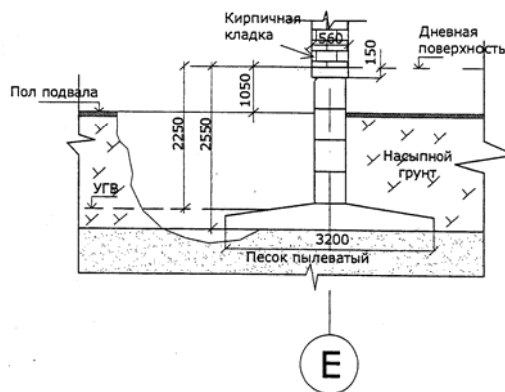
Конструкция фундамента внутренней несущей стены по оси Е
